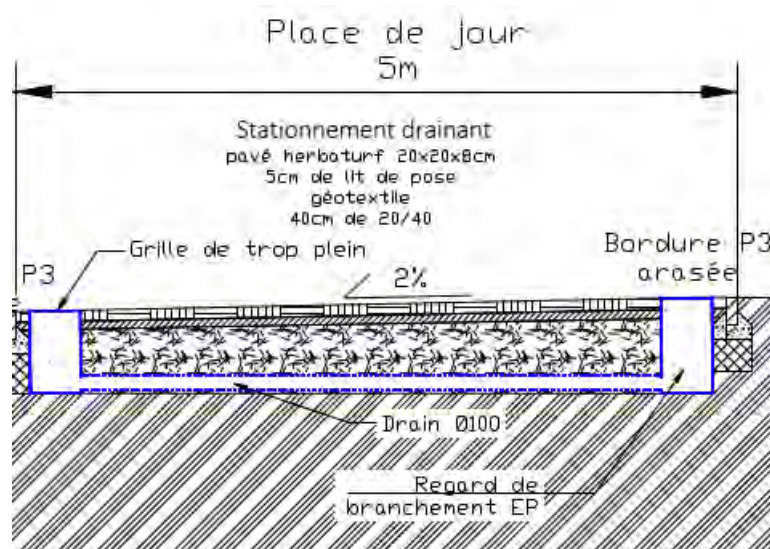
Coupe sur la structure drainante au droit entrées de lots (Source : SODEREF)
